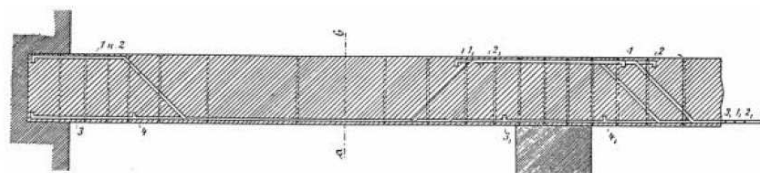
Bewehrungsführung nach Wayss [130]
